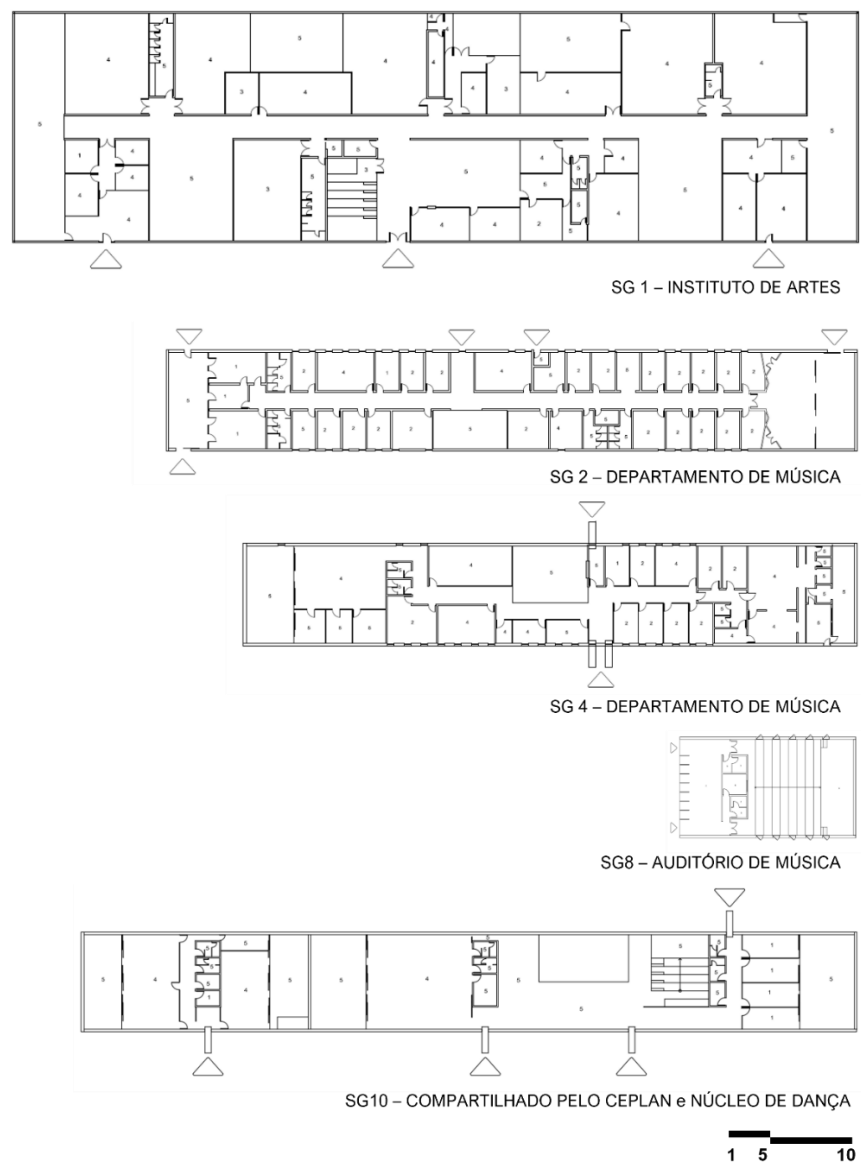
planta baixa de dois blocos de Serviços Gerais da UnB
